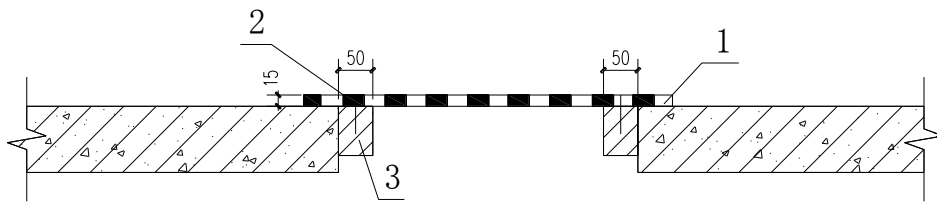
洞口盖板防护做法剖面示意图（单位：mm）
